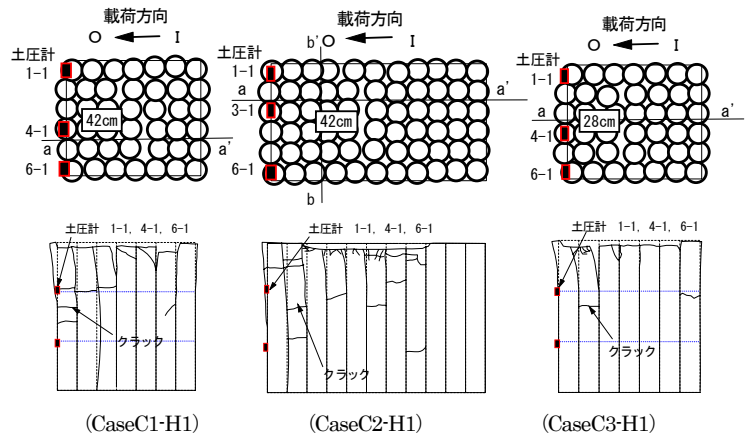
固化体の損傷状況 (上：平面図, 下：側面図)
